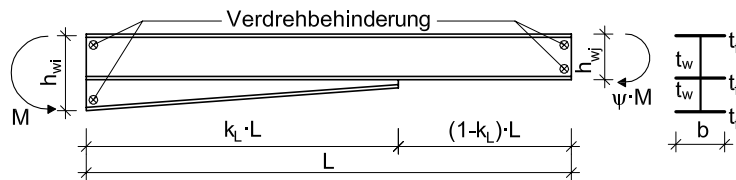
Walzprofil mit Voute – Einzelstab mit gevoutetem und konstantem Bereich
